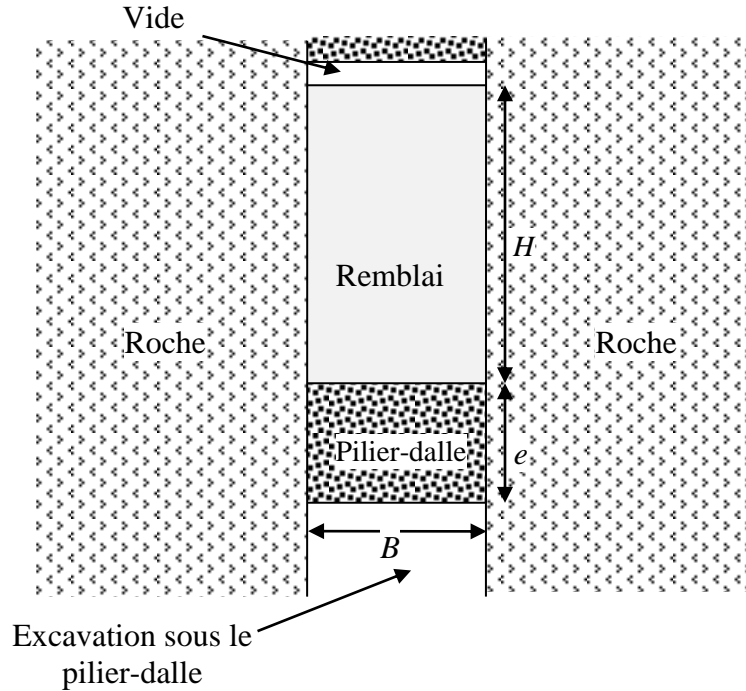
Schéma d'une excavation sous un chantier minier soutenu par un pilier-dalle.
